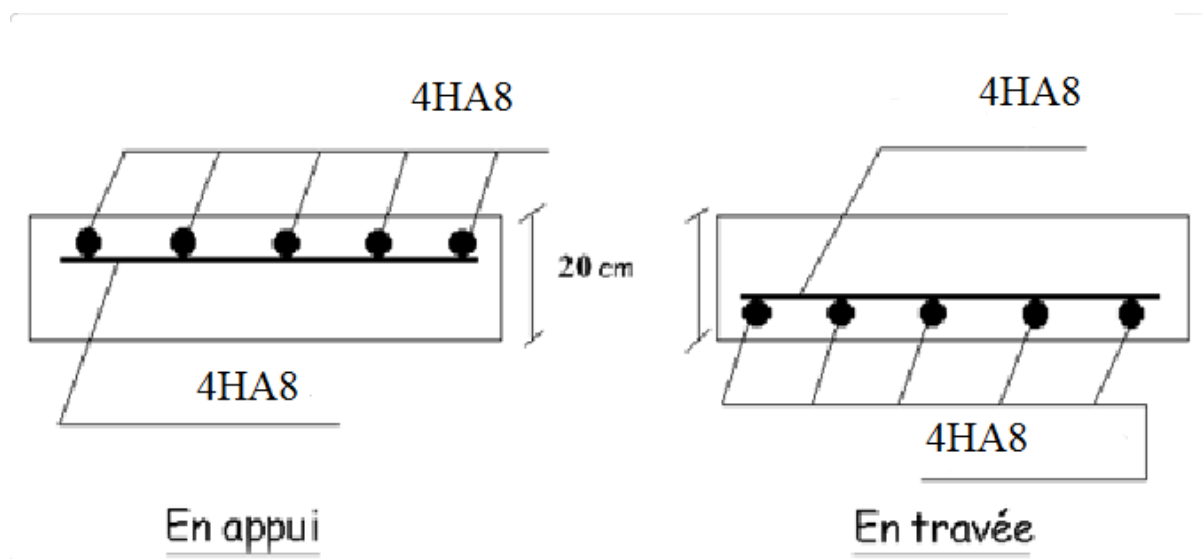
Schéma de ferrailage de la dalle au-dessous (sous charge répartie)
